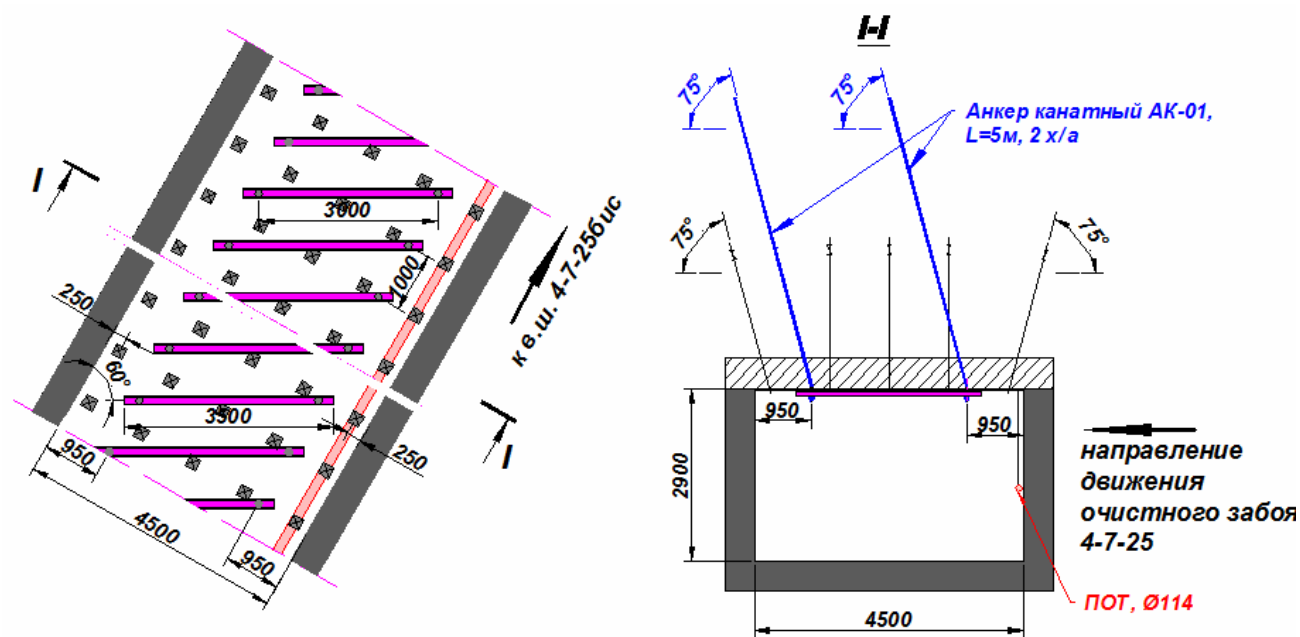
Схема усиления крепления кровли ПРП 4-7-25
